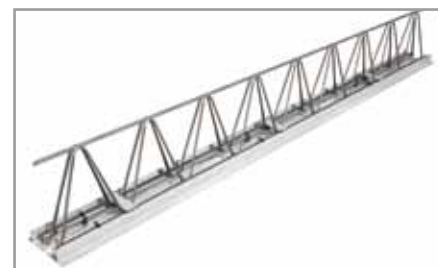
Балка перекрытия МАРКО-УНИВЕРСАЛ
